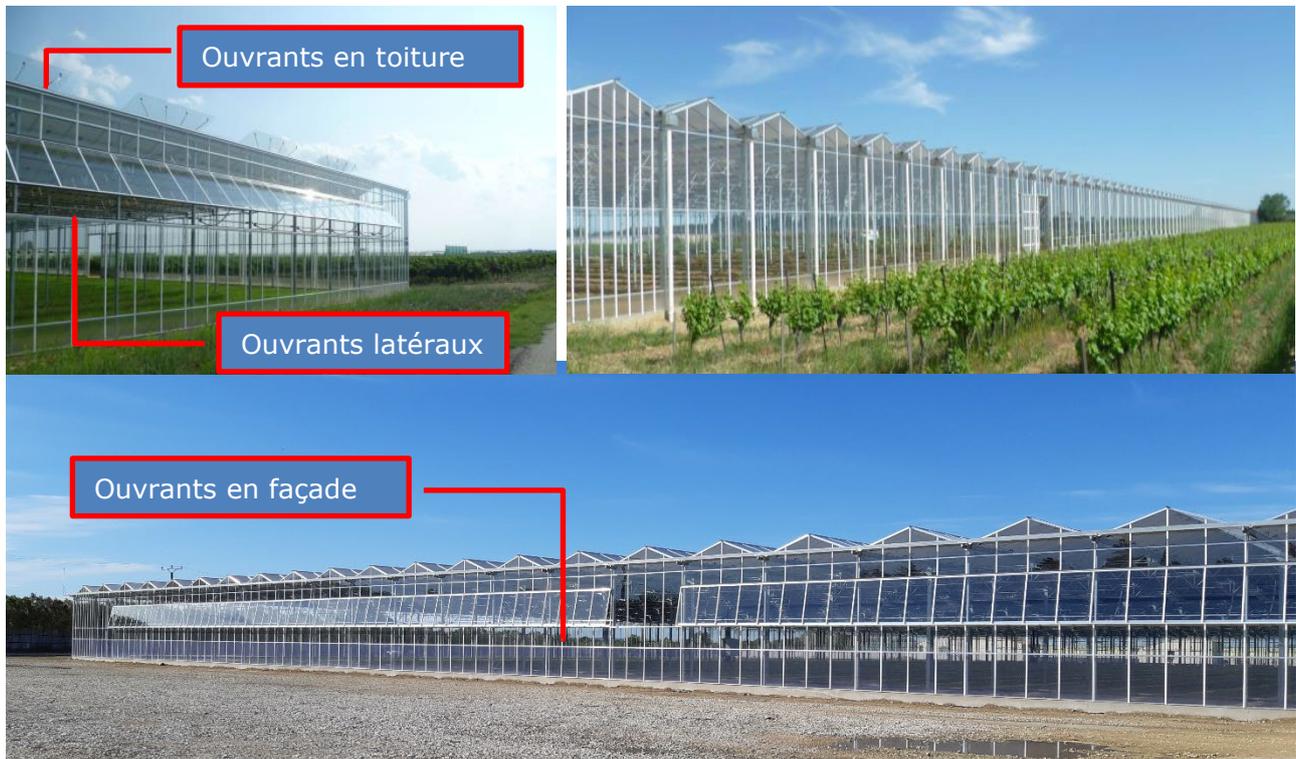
Ouvrants en façade et en toiture. Source : Reden Solar.
